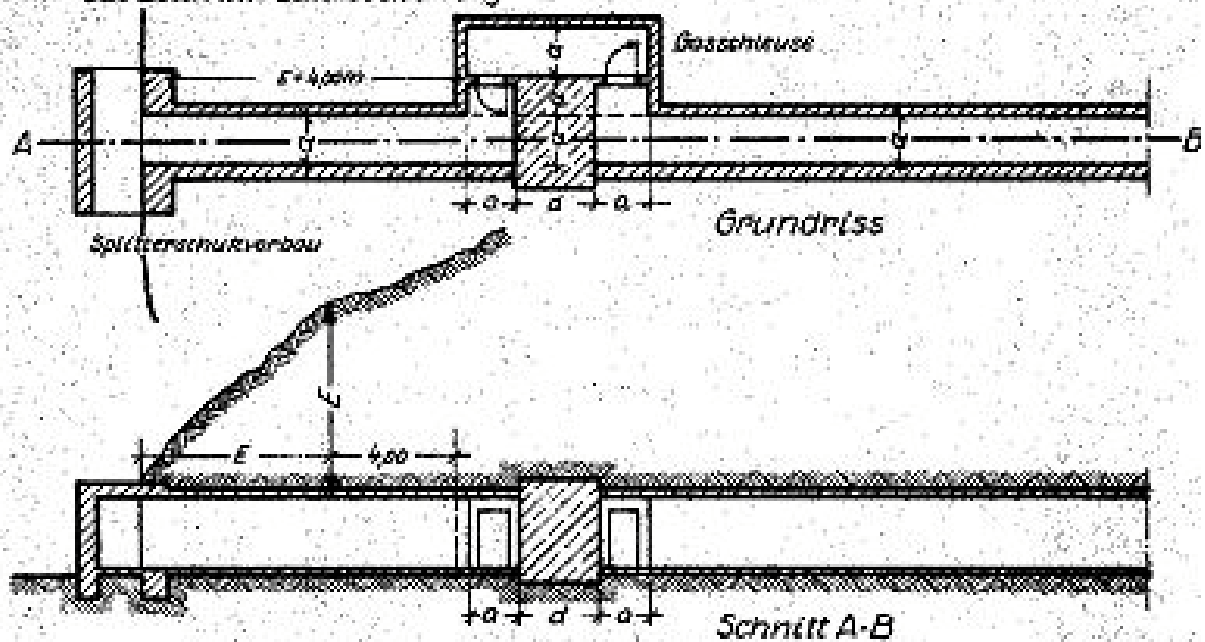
Ausführungsbeispiele für Eingangsbauwerke zu Hangstollen
